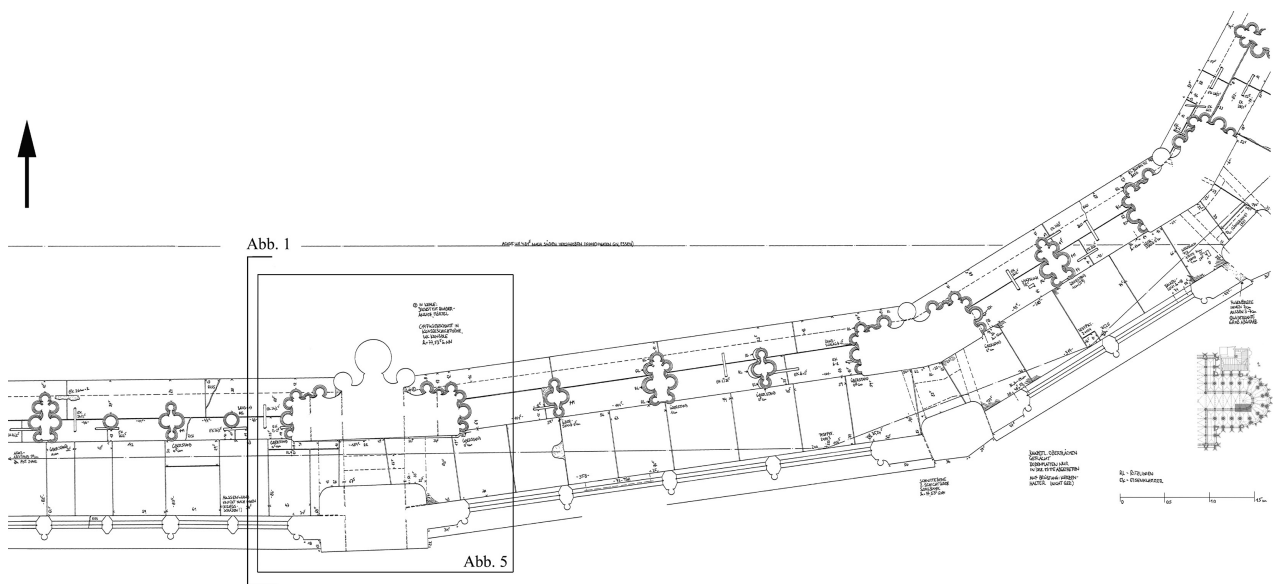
Köln, Dom, Teilgrundriss des Triforiums, Übergang vom südlichen Langchor zum Polygon (Schnittführung Abb. 1 und Ausschnitt Abb. 5)
